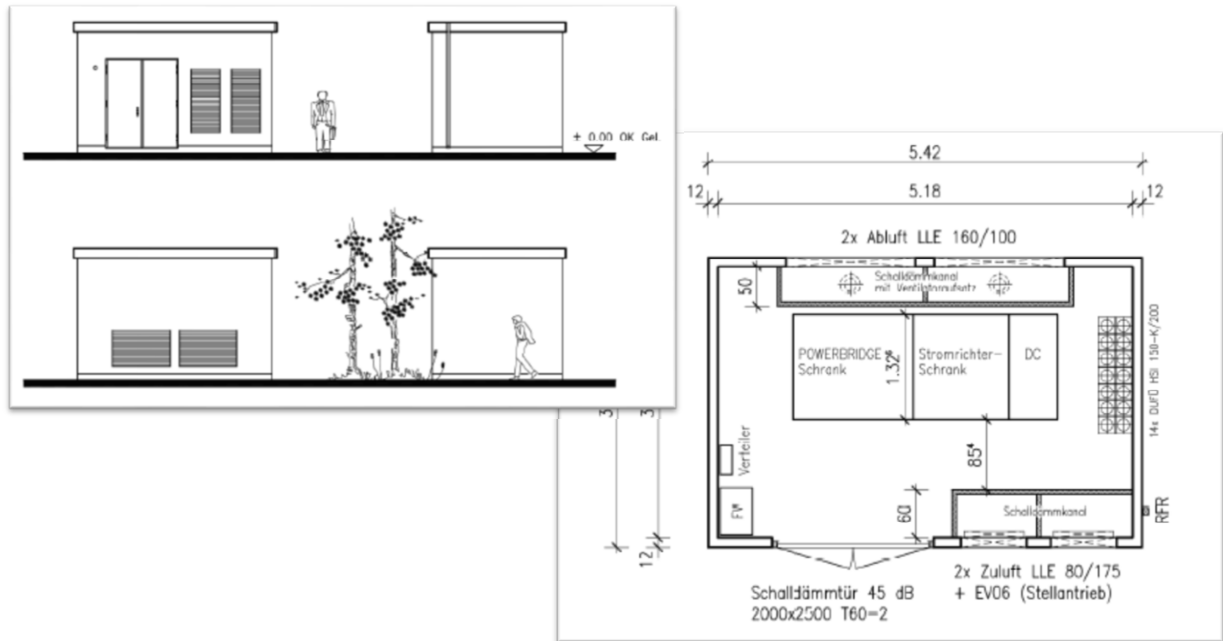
, 10: Ansichten und Grundriss Gebäude (Quelle: Ausschnitt Baueingabeplan Fa. Betonbau)
